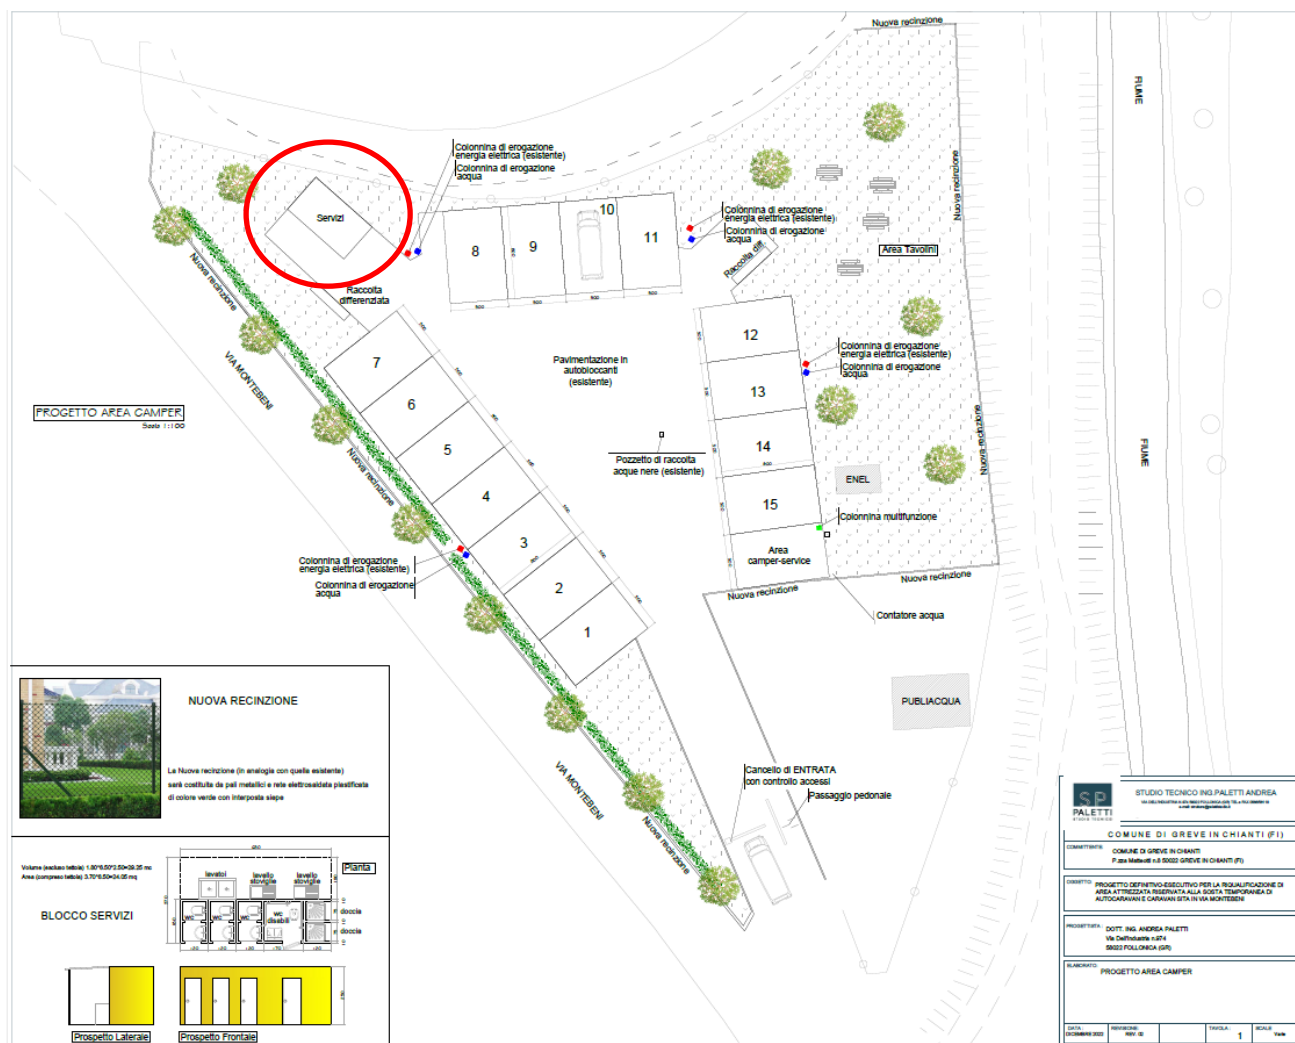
Estratto della planimetria del progetto del blocco servizi dell'area camper
